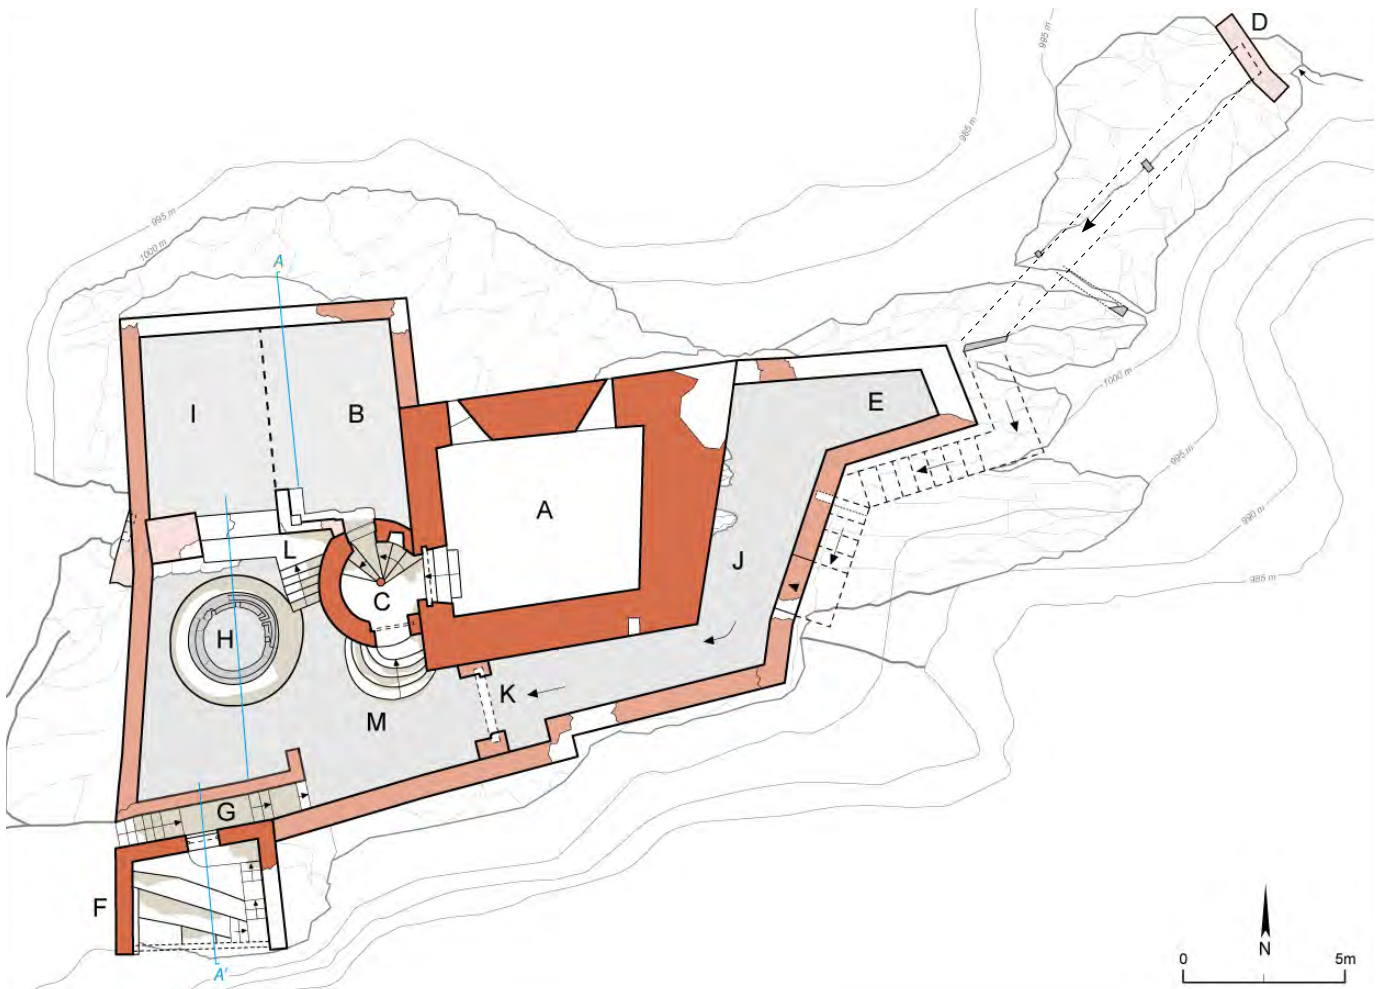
Plan du château fin 2011, avec emplacement de la coupe nord - sud.
